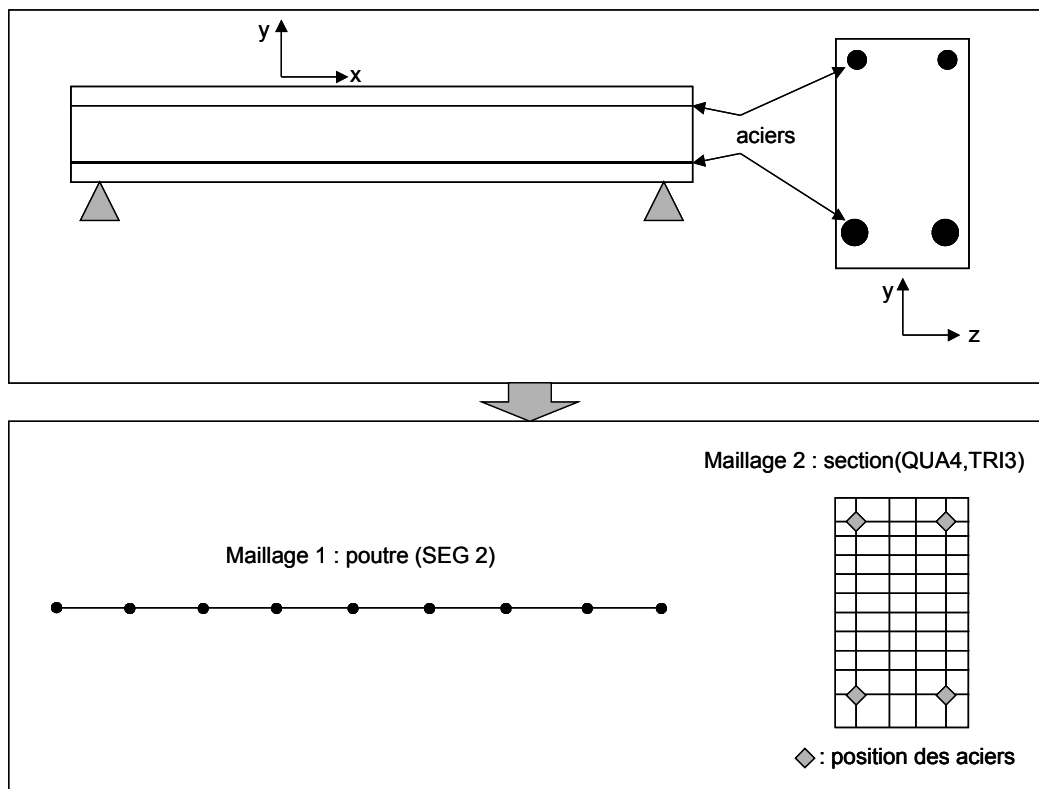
a : modélisation poutre multifibre d'une poutre en béton armé.
